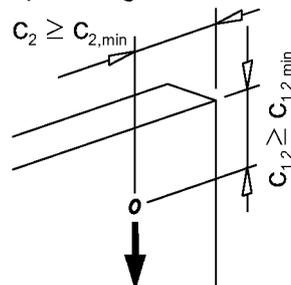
Einbausituation Querbeanspruchung ohne Betonkantenbruch, ohne Rückhängebewehrung
